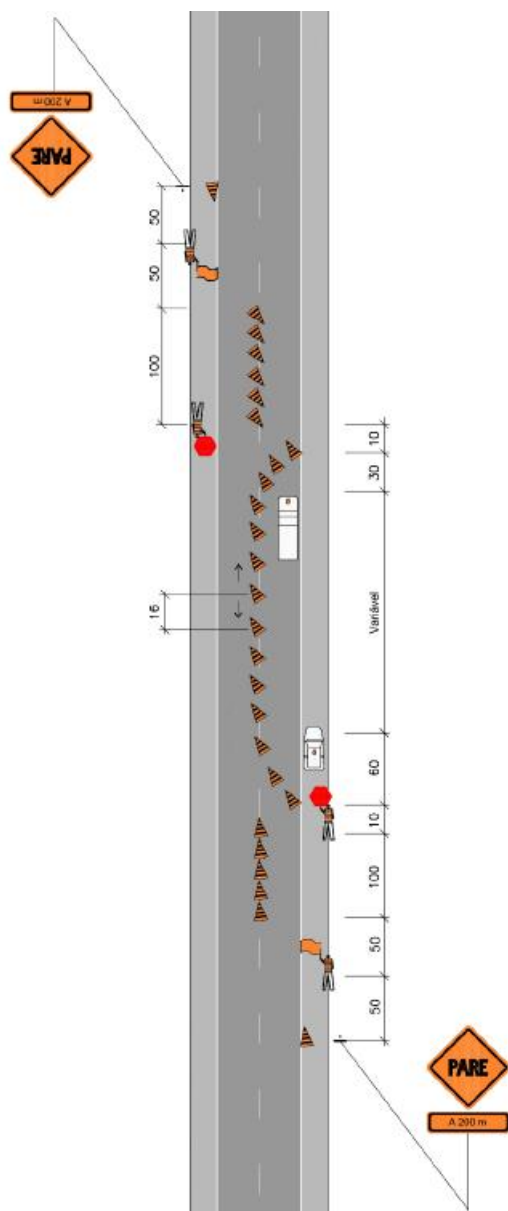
Modelo de esquema de sinalização para interrupção parcial de tráfego
